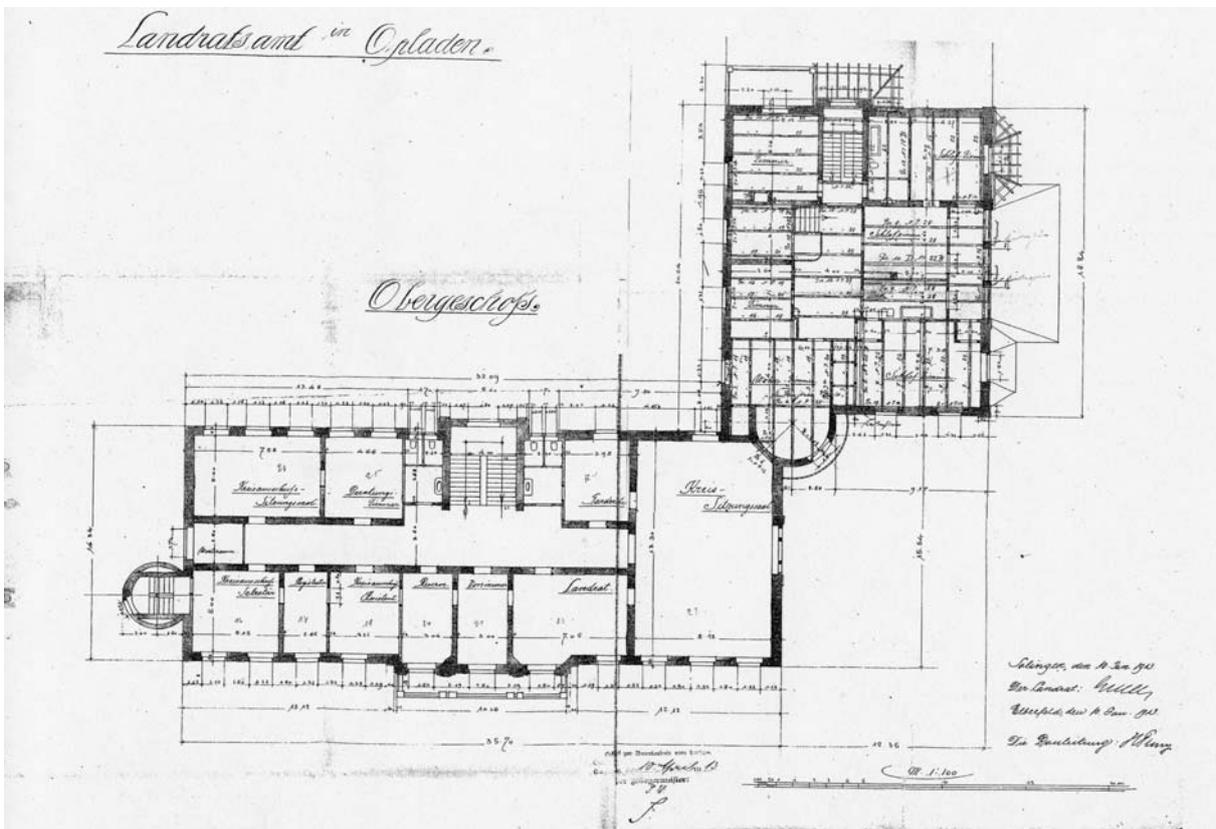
H. Plange, Grundriss Obergeschoss des Landratsamtes in Opladen, 1913
